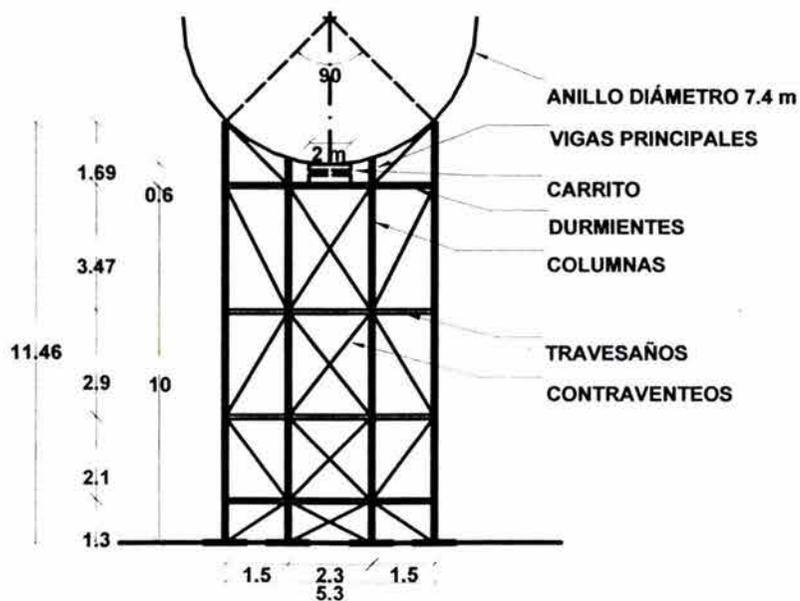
ARREGLO GENERAL DE LA ESTRUCTURA
